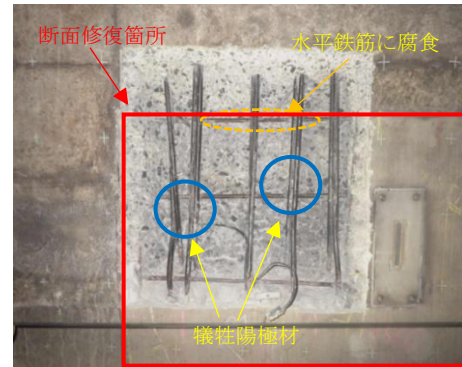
鉄筋腐食状況 No. 12 (大島川A線 13k558m)
